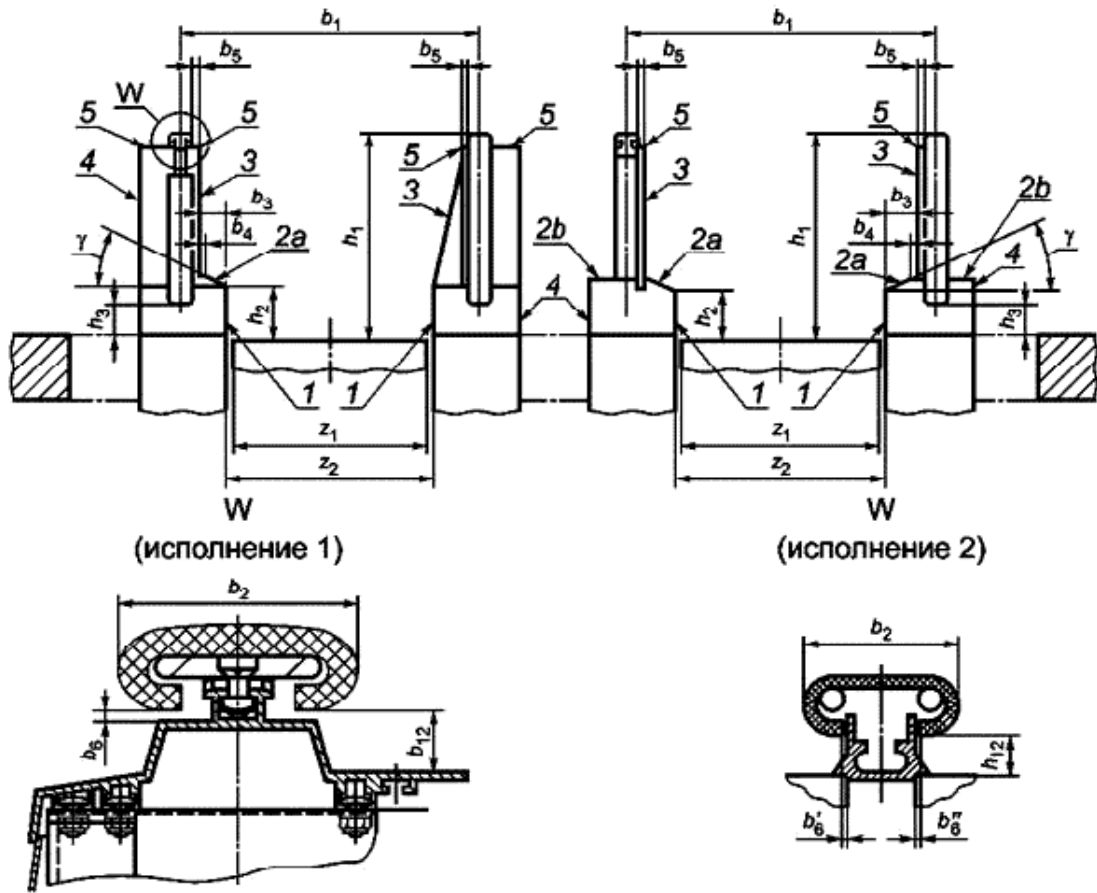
Эскалатор или конвейер пассажирский (вид в разрезе), основные размеры
